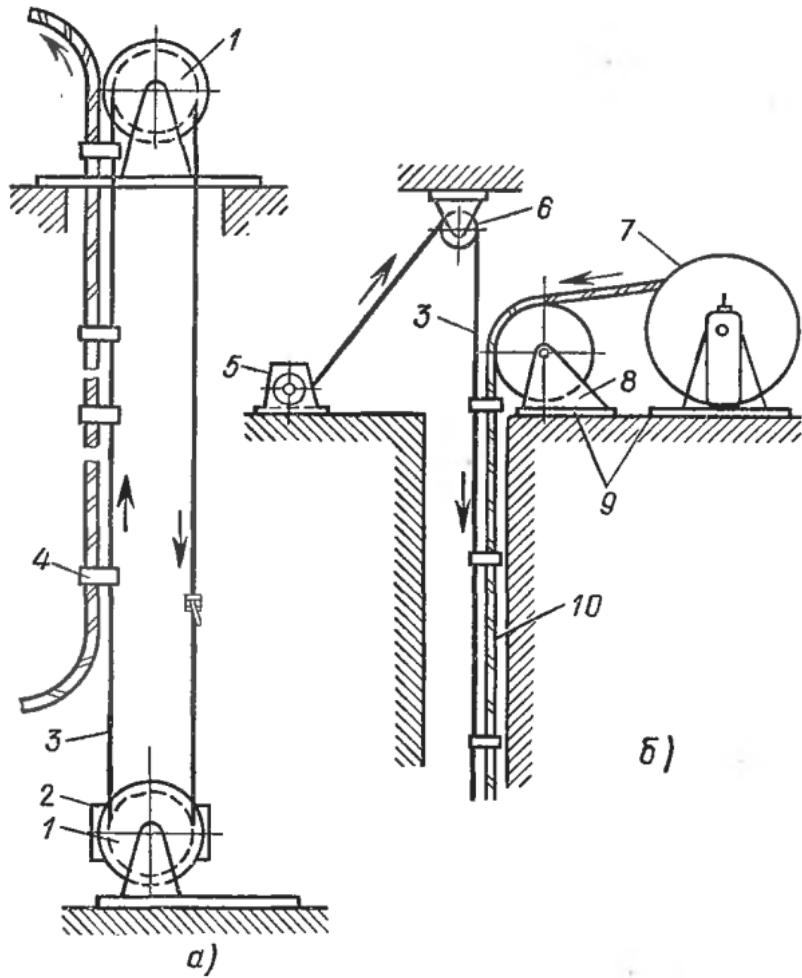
Вертикальная прокладка кабеля с помощью электропривода (а) и лебедки (б):
